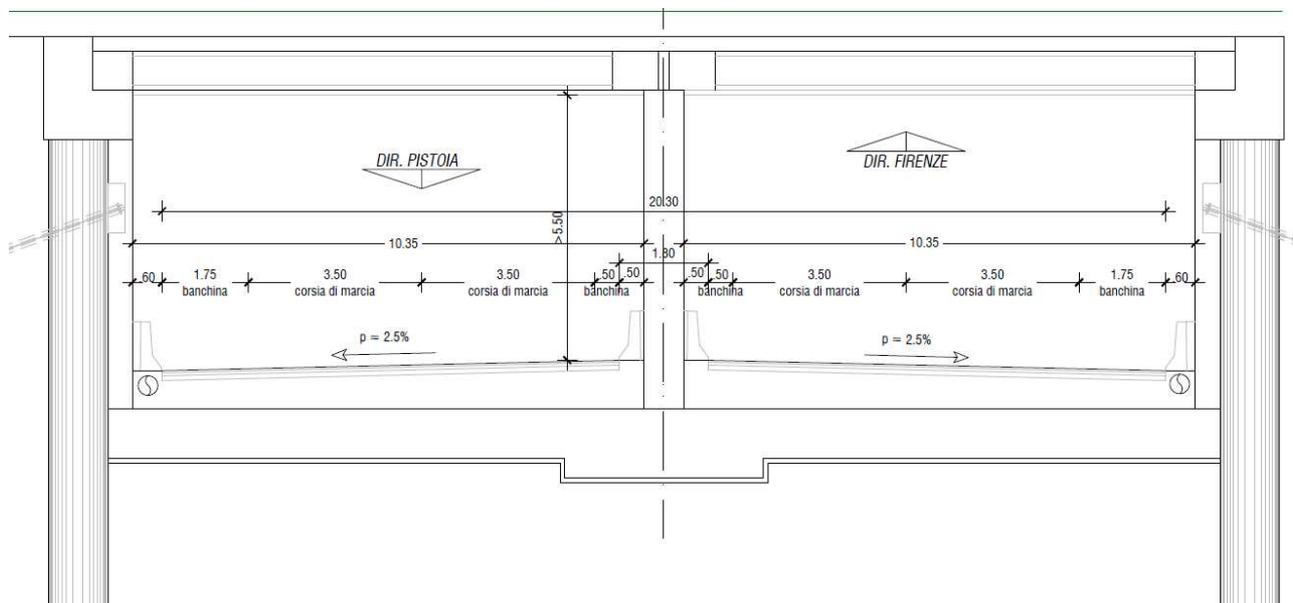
Sezione tipo "ASSE PRINCIPALE"
